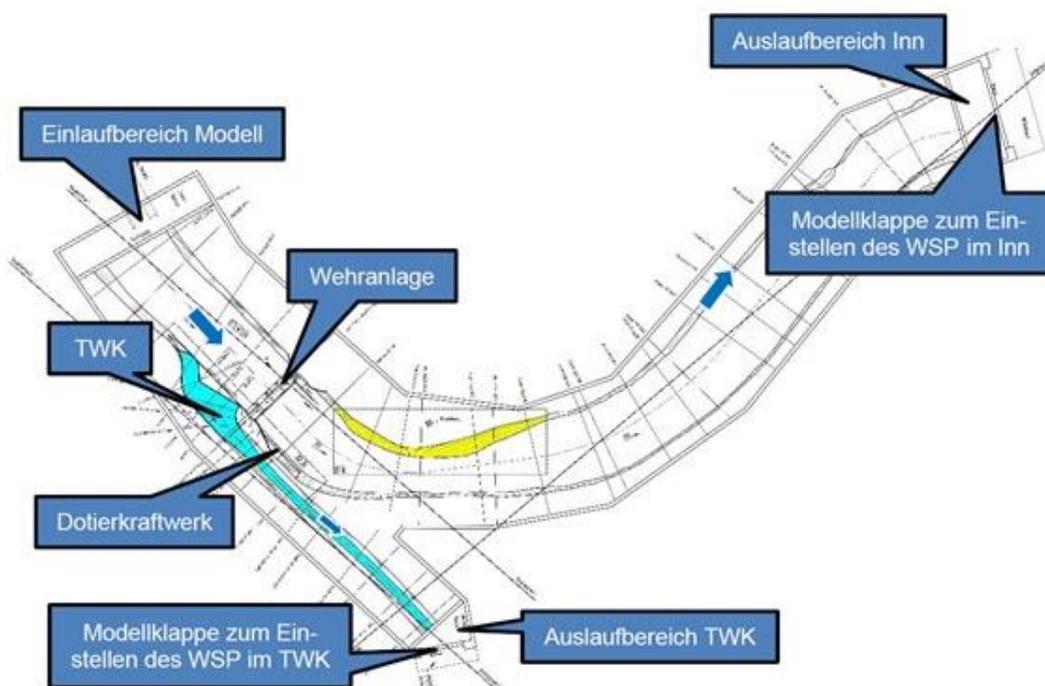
Modelllageplan Kirchbichl 1 [1]
